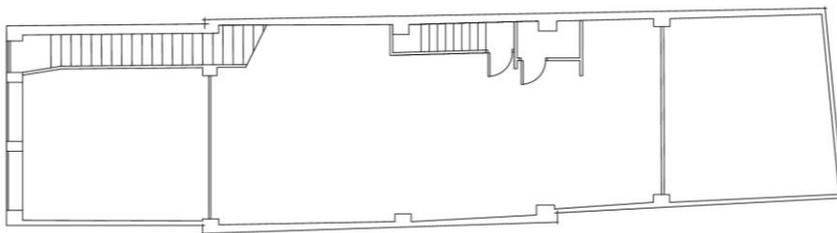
Plano distribución de planta intermedia. 2018. Fuente: Propia
